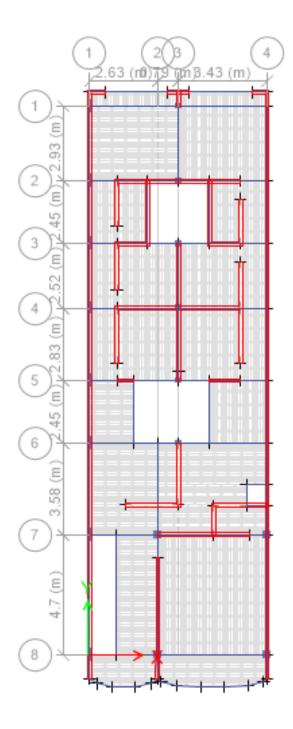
Esquema del edificio en planta (e=020cm) (ETABS 2016)
